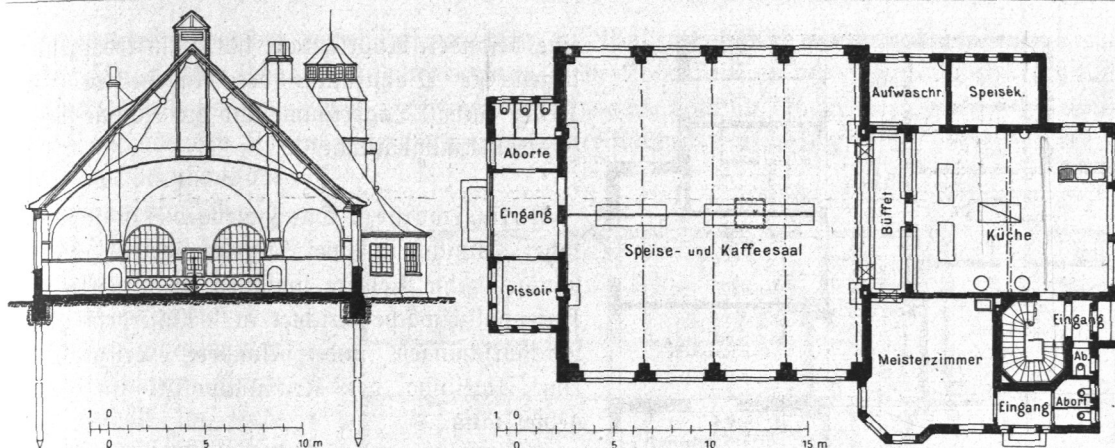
und 150. Speisehalle am Bremer Kai, Querschnitt und Grundriss.
